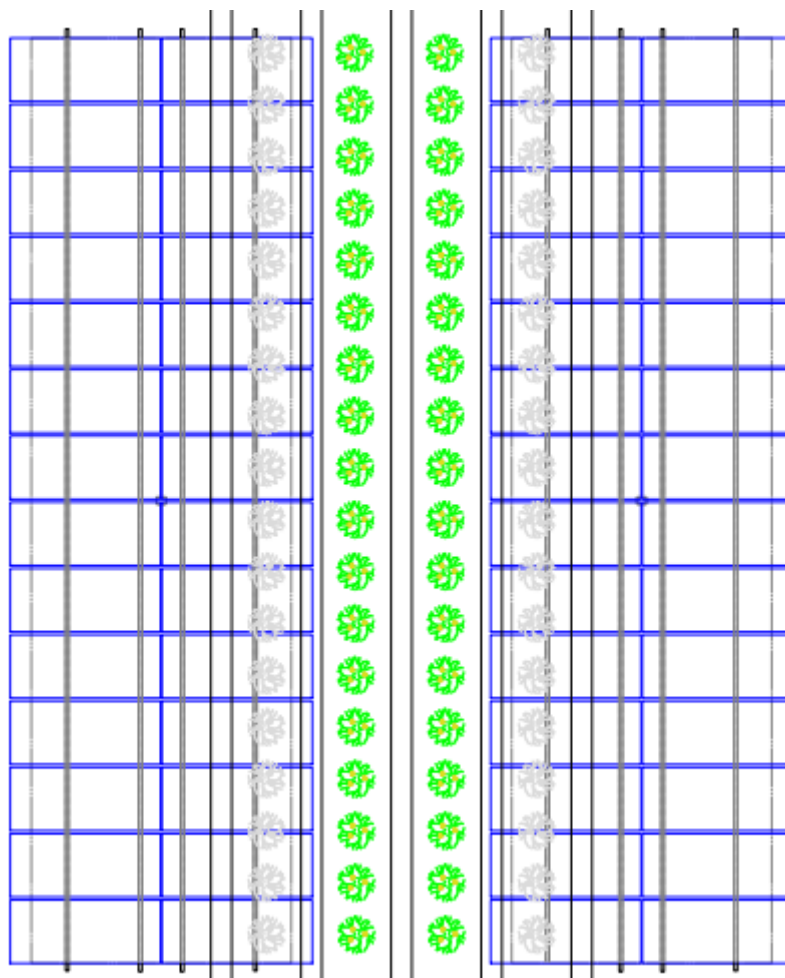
Piantumazione tra le file di tracker (vista dall'alto)
